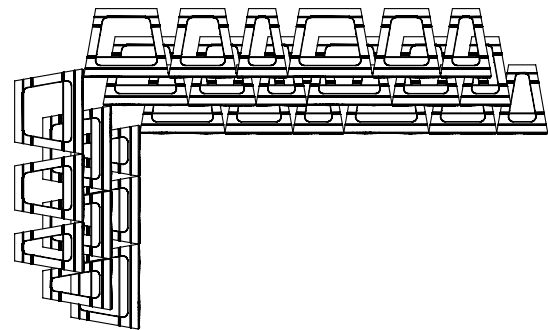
Grundriss Innenecke mit Rücksprung 16,5 cm
